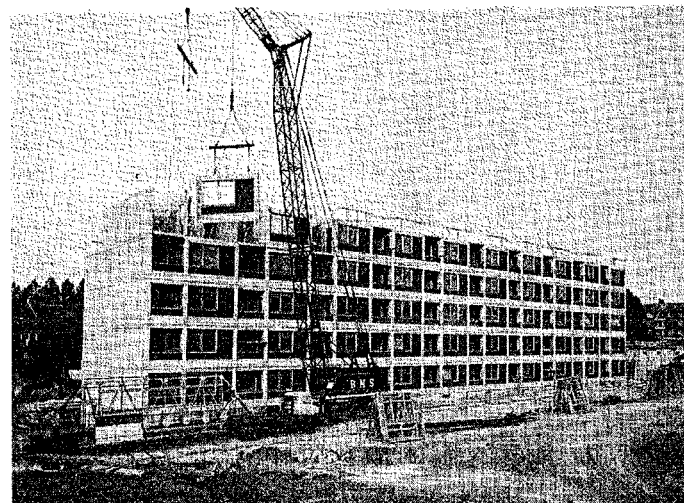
Hareskovvej. Montage af facadeelementer. Facaden leveres færdig med indstøbte vinduer med glas.
